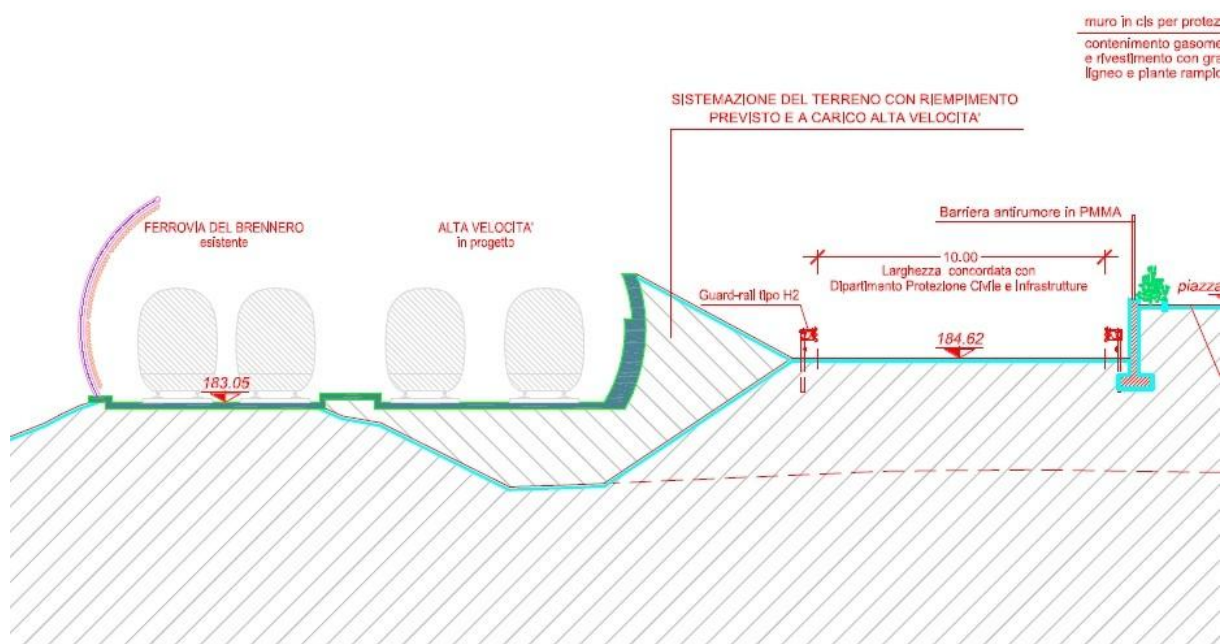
estratto di una sezione progettuale dell'impianto di depurazione, si osserva lo spostamento della SS12 a fianco della ferrovia del Brennero e dell'alta velocità (in progettazione).
